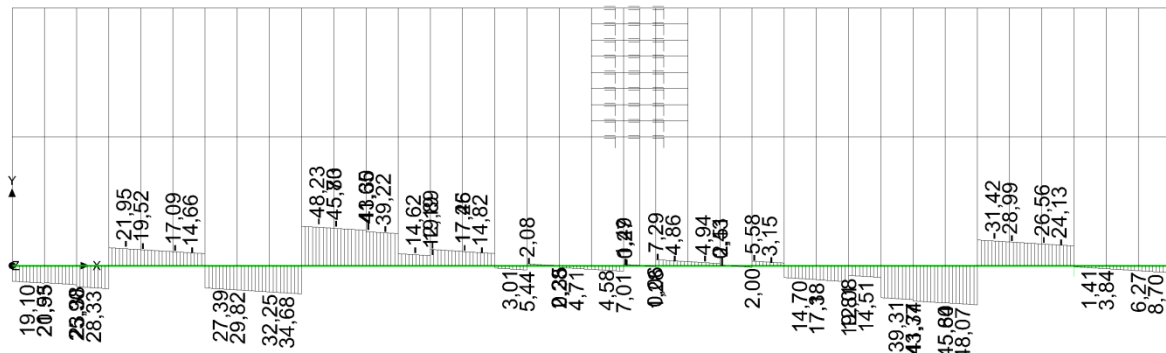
Dolní pas – krajní – 8 uražených pilířů
